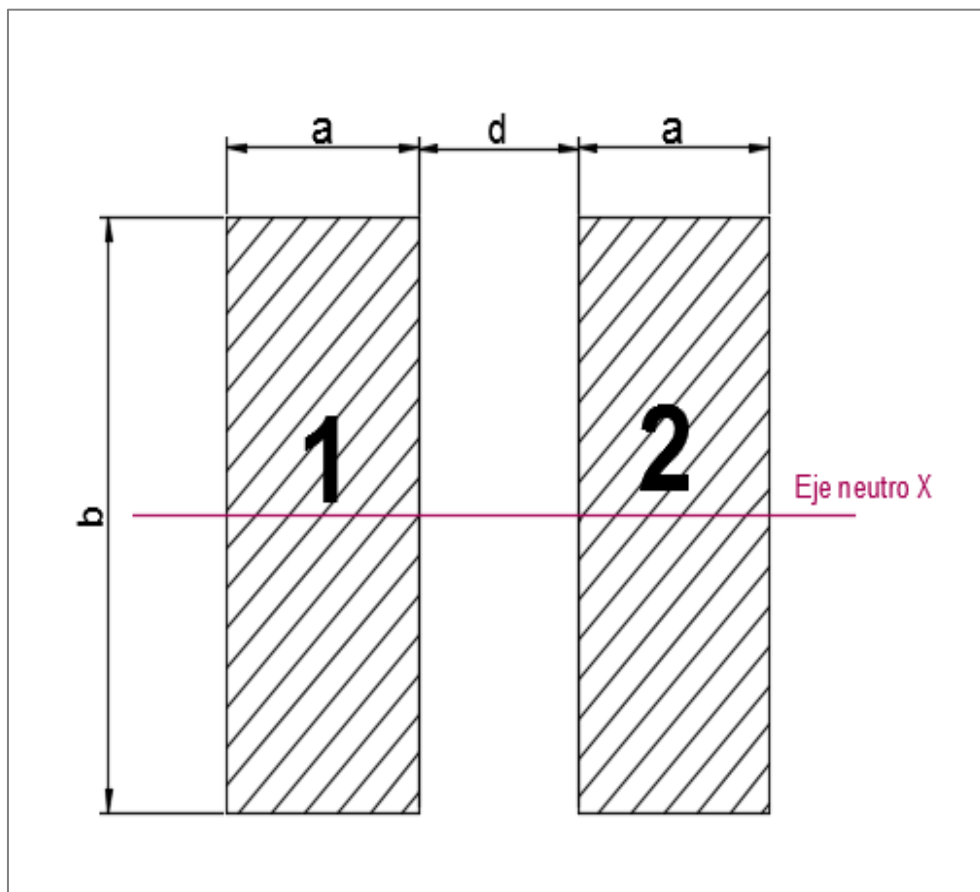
4: Sección transversal de viga propuesta. (Elaboración propia, 2 017)
